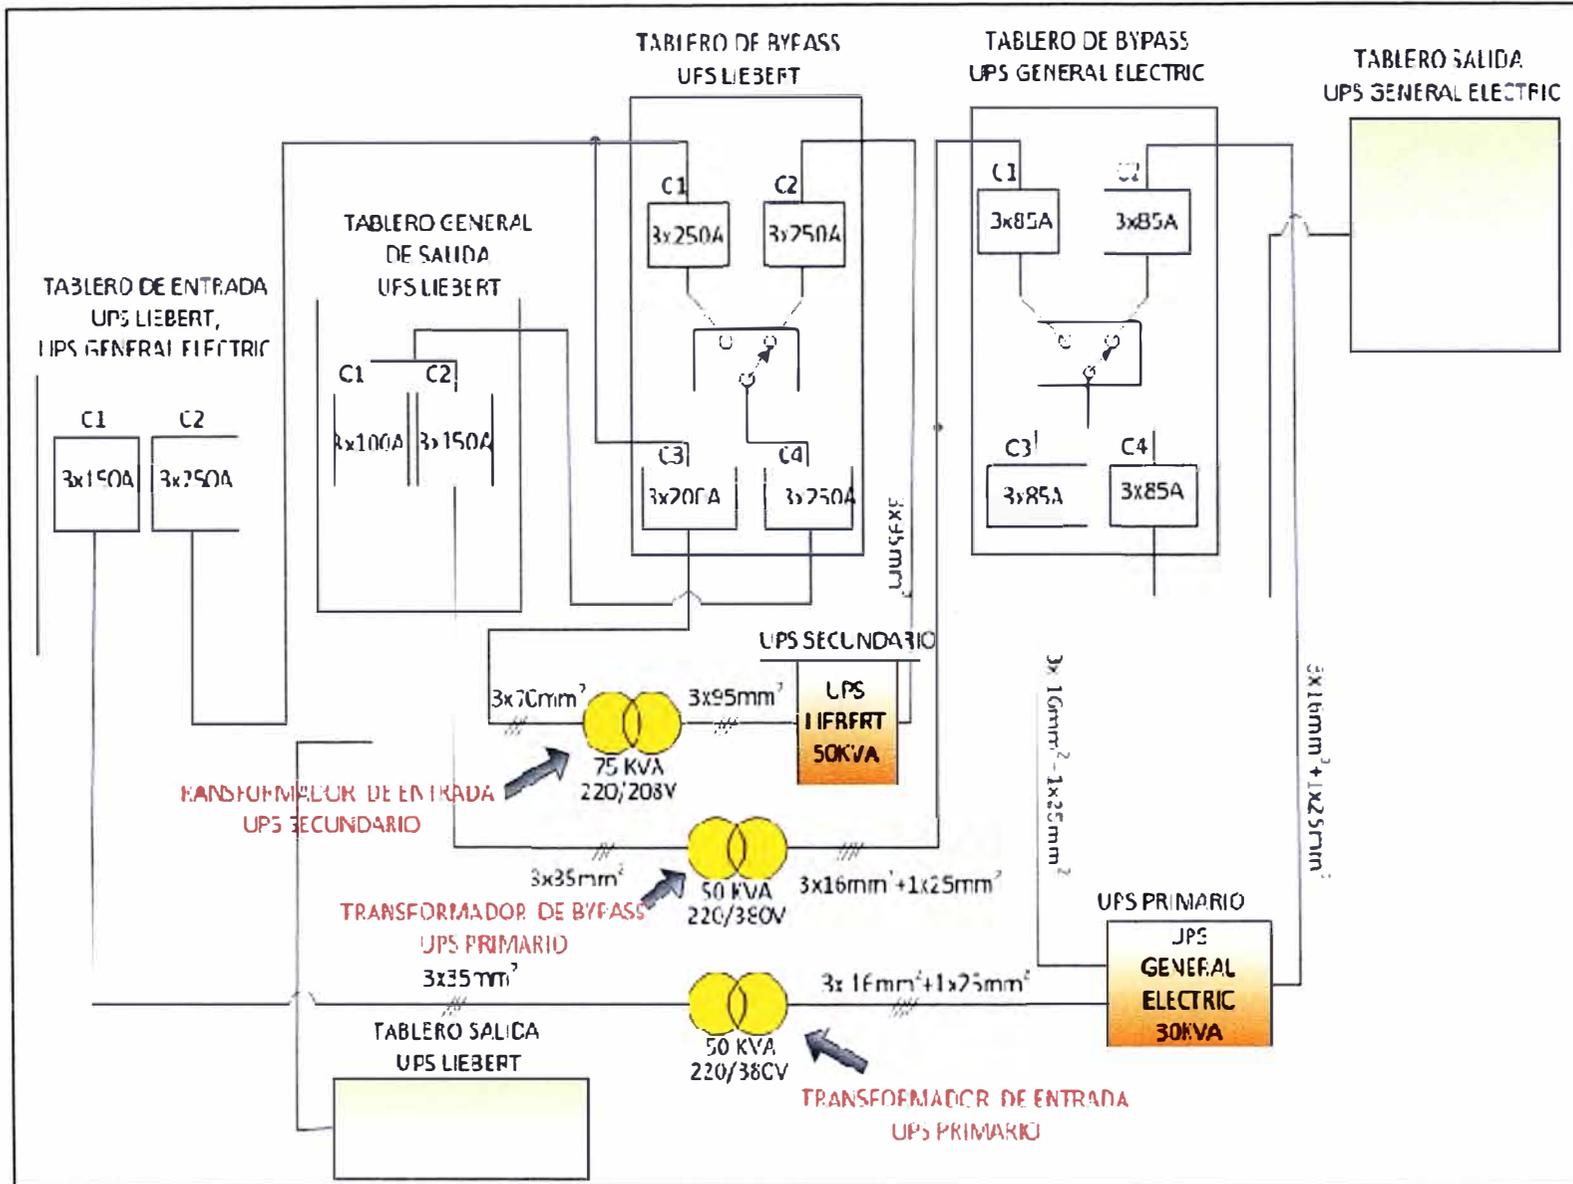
Diseño de un sistema redundante aislado para dos equipos UPS
